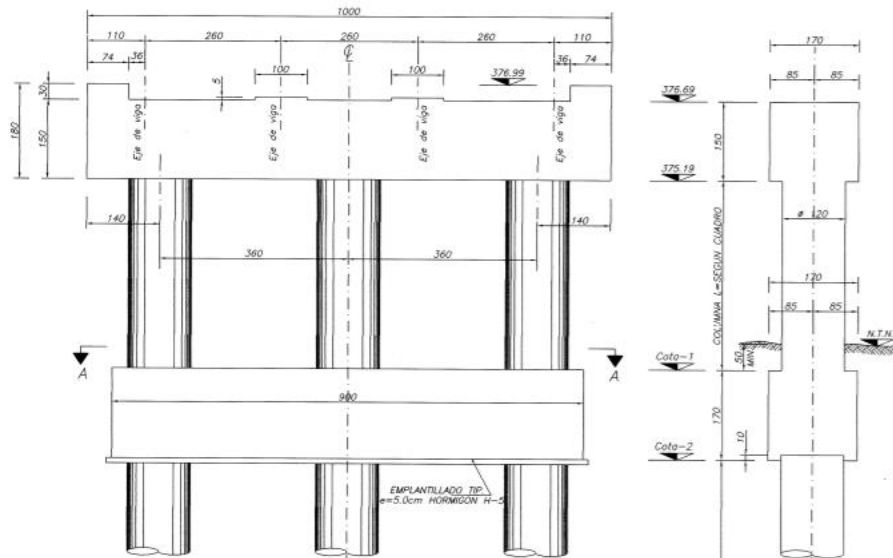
Plano de cepa de puente Águila Norte. Planos Puente MOP [41].
